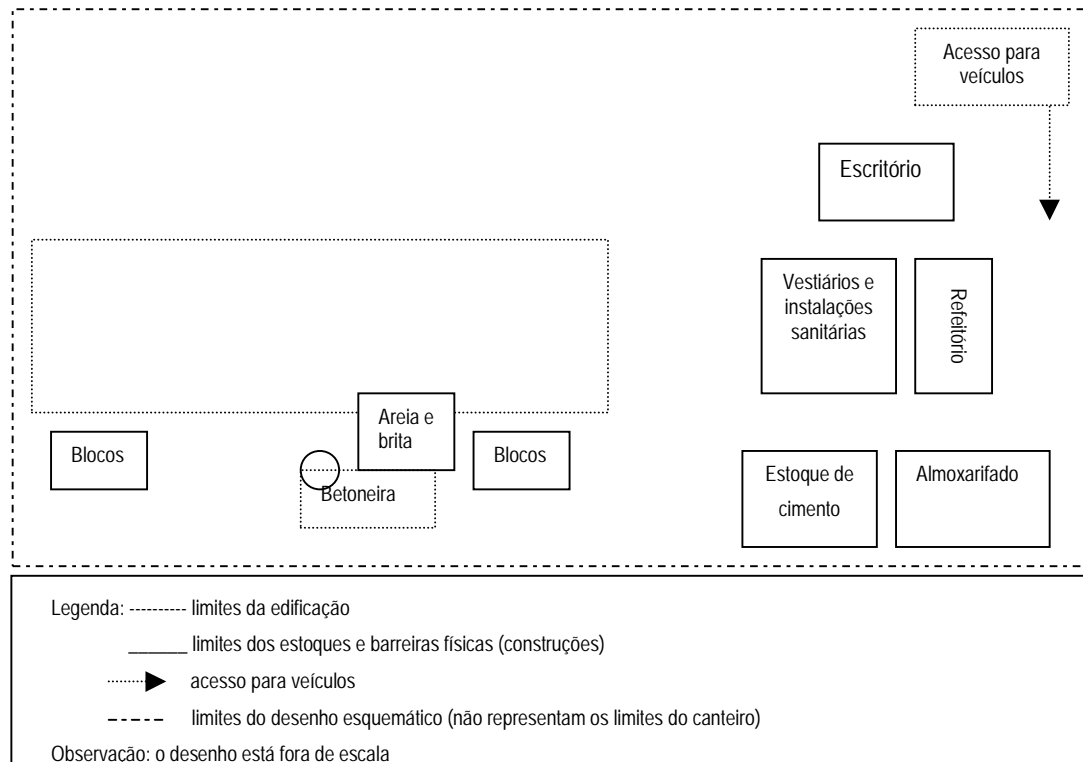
Desenho esquemático do canteiro de obras da Empresa B<sup>21</sup>
